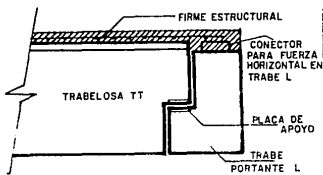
Detalle entre losa "TT" de entrepiso y traves seccion "T" invertida y "L".
